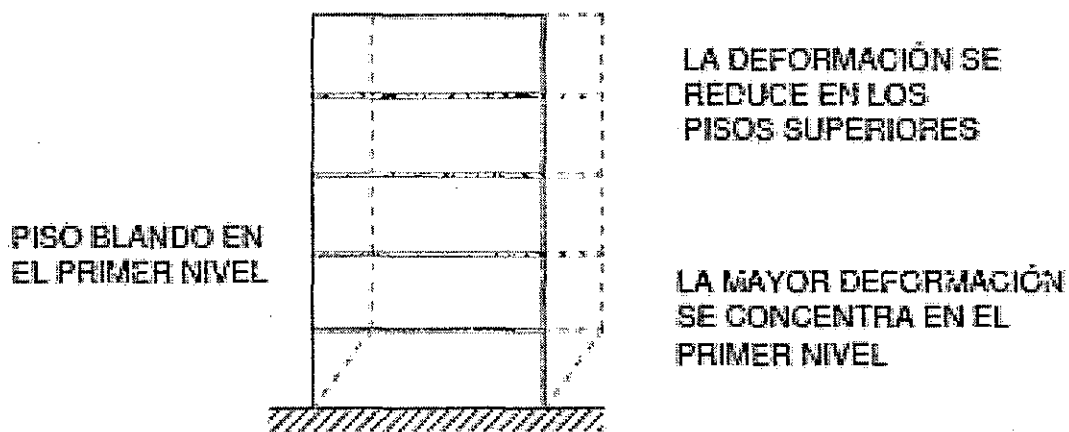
Sistema de piso blando (planta baja flexible) con deformaciones controladas.
